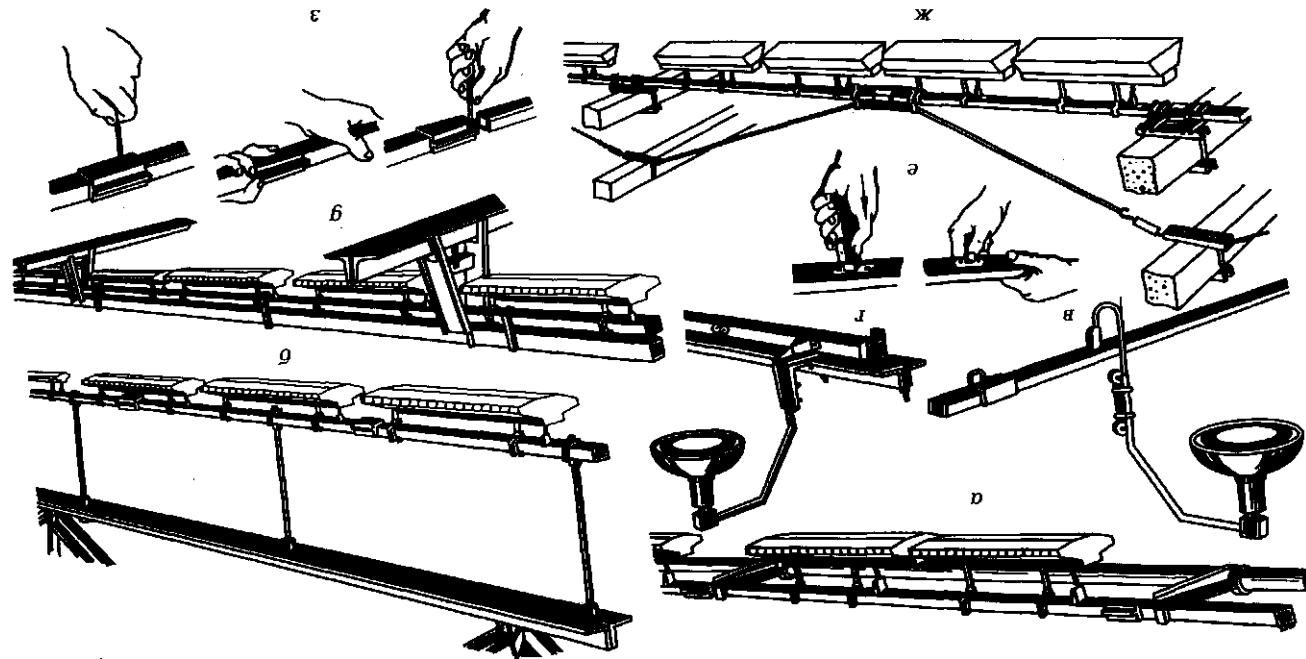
Монтаж осветительных шинопроводов ШОС:
